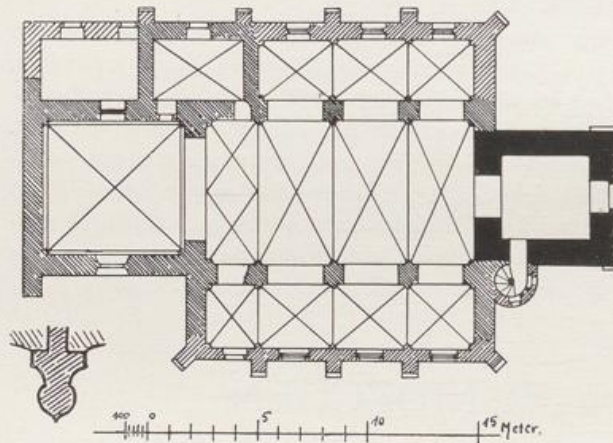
Berg vor Nideggen. Grundriss der kath. Pfarrkirche.
